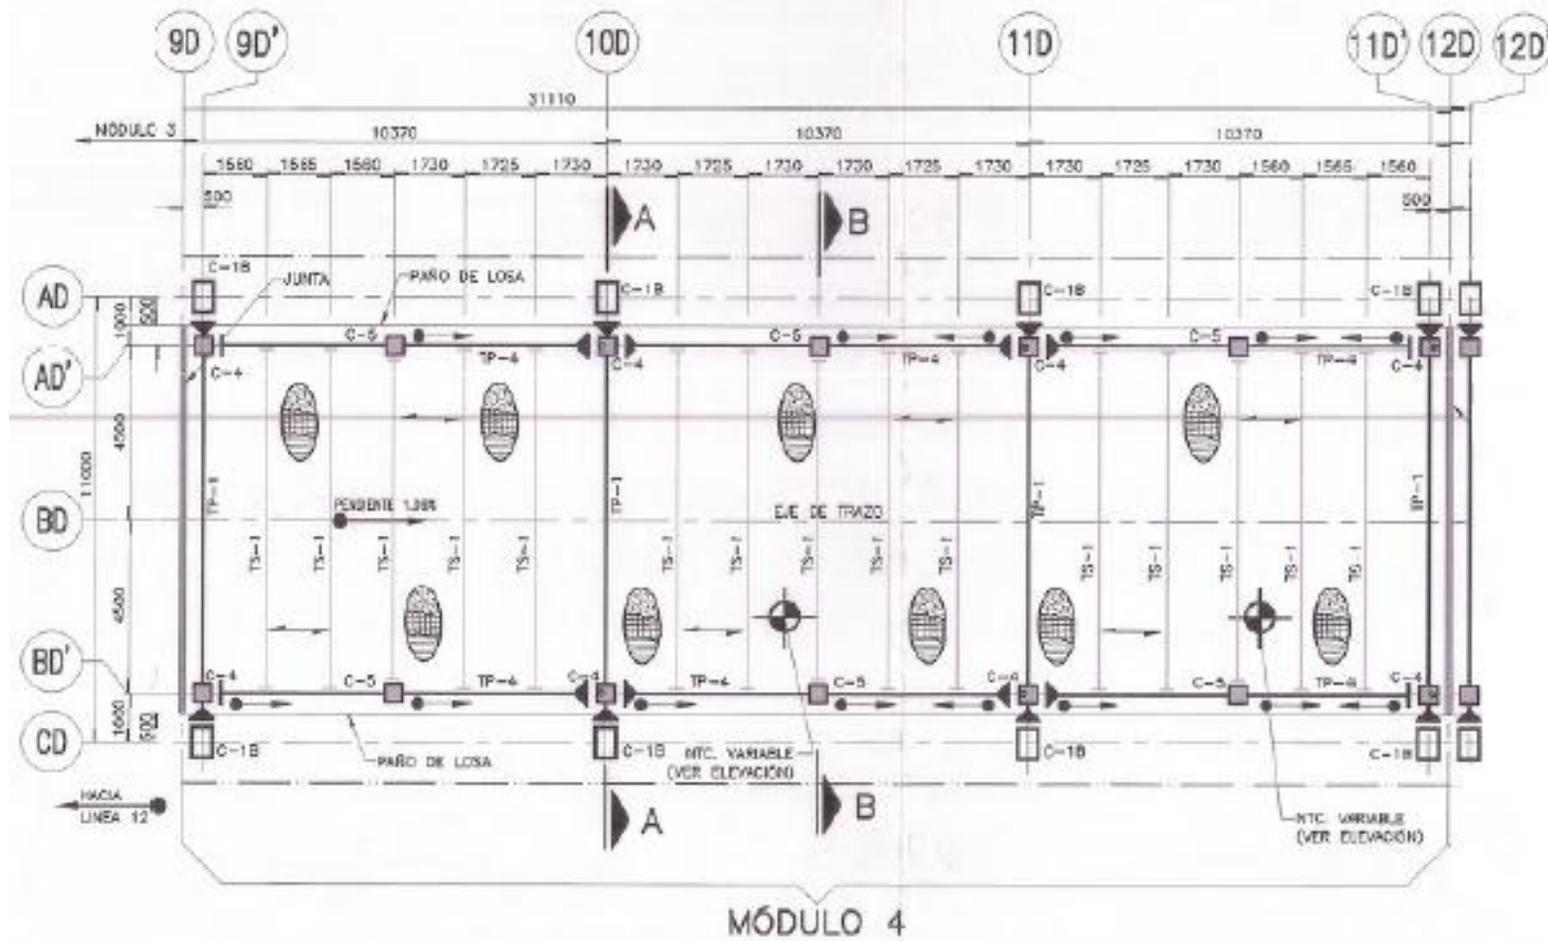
Planta de estructuración nivel pasarela, módulo 4.
